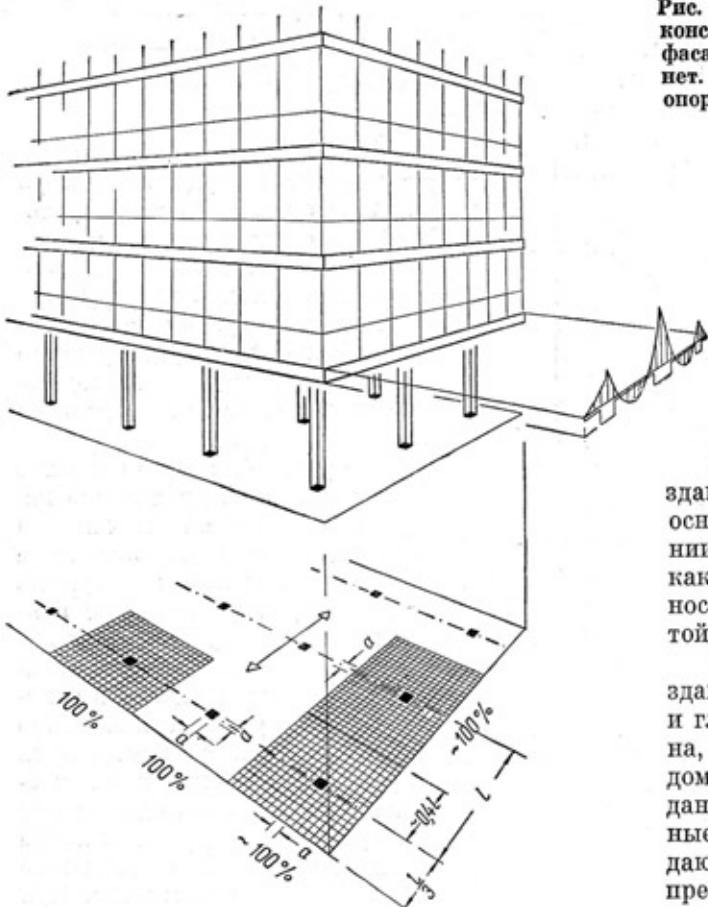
Схема распределения нагрузок в каркасной конструкции с широким шагом при консольном выносе фасада по всему периметру здания. Угловых колонн нет. Нагрузка равномерно распределяется на все опоры.
